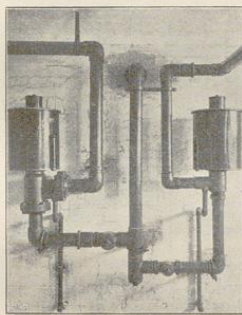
Gasverteilung für das Erdgeschoß und I. Stockwerk im östlichen Laboratoriengebäude (Raum 556).
